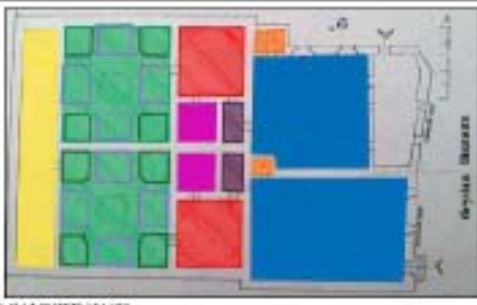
Meydan (Şifa) Hamamı plan [3]
